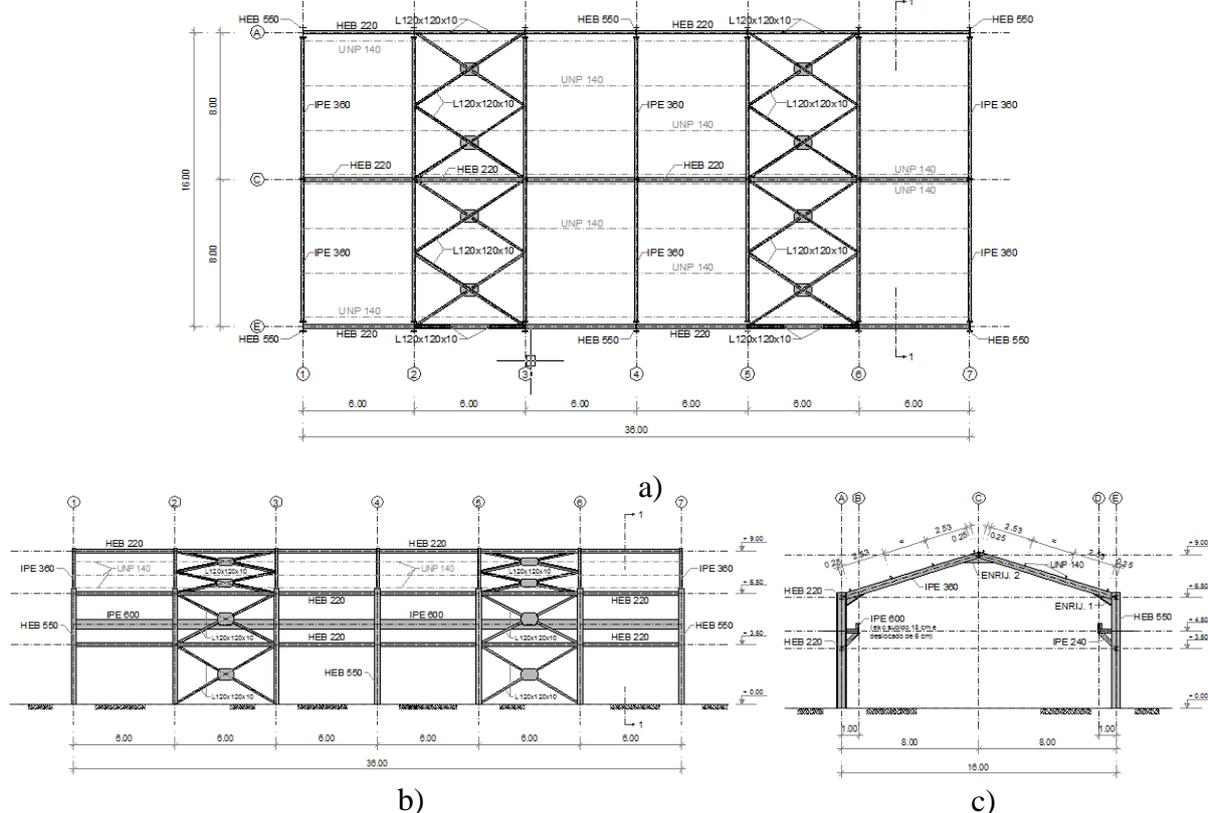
Pavilhão metálico: a) planta da cobertura; b) alçado lateral; c) corte transversal.
